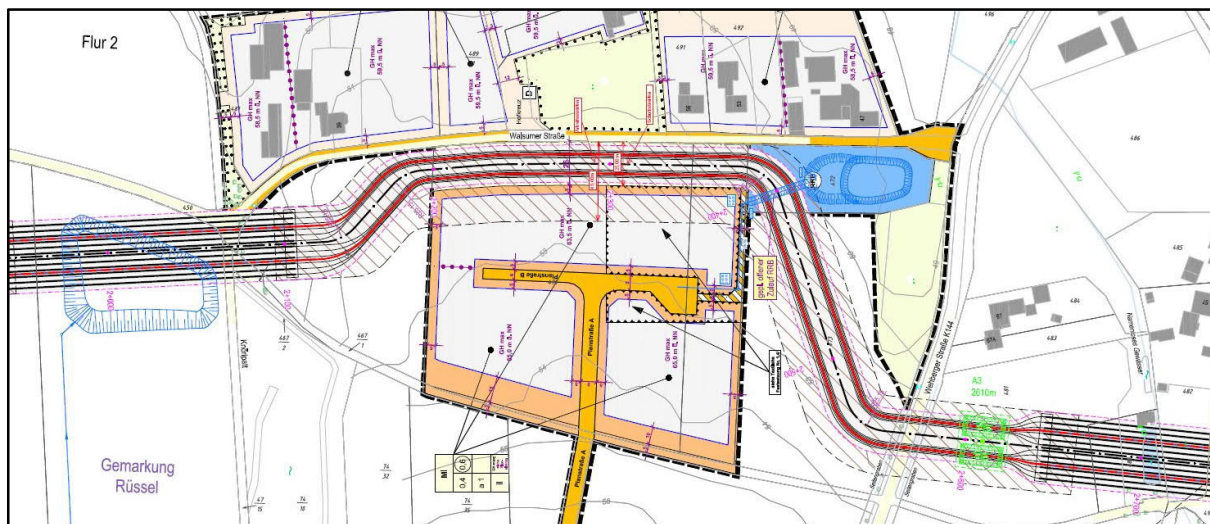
Trassenführung der Höchstspannungsleitung (Quelle: Amprion 2021)
